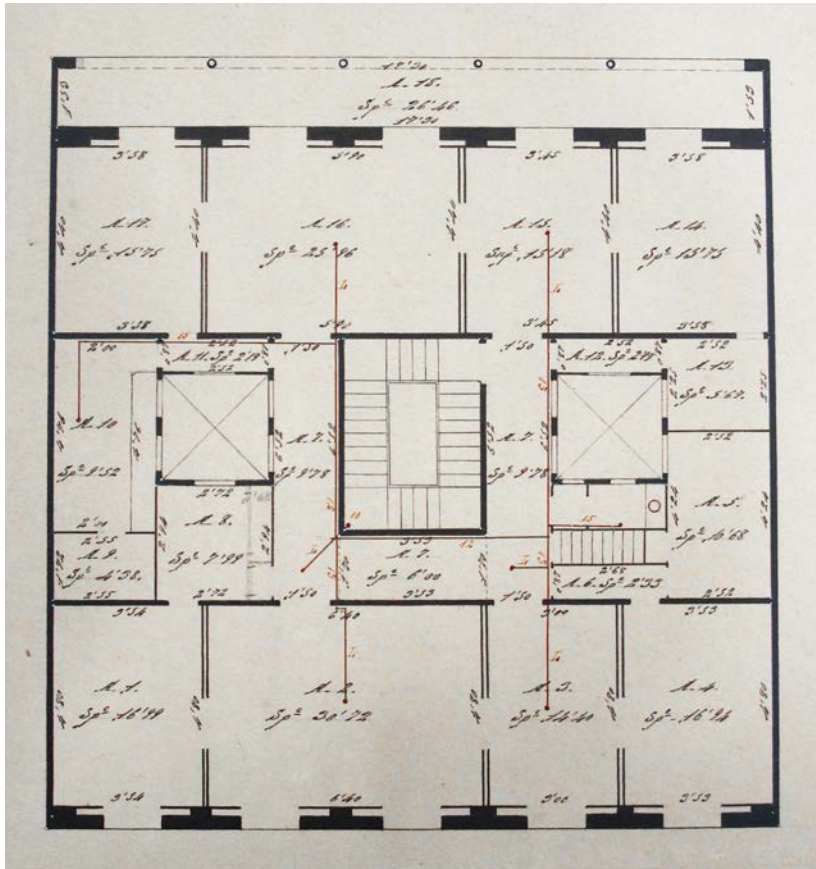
Plànol de planta del primer pis (casa Antoni Domingo, arquitectes Bassegoda, 1873). Font: AHCOAC H121F/5/579.
